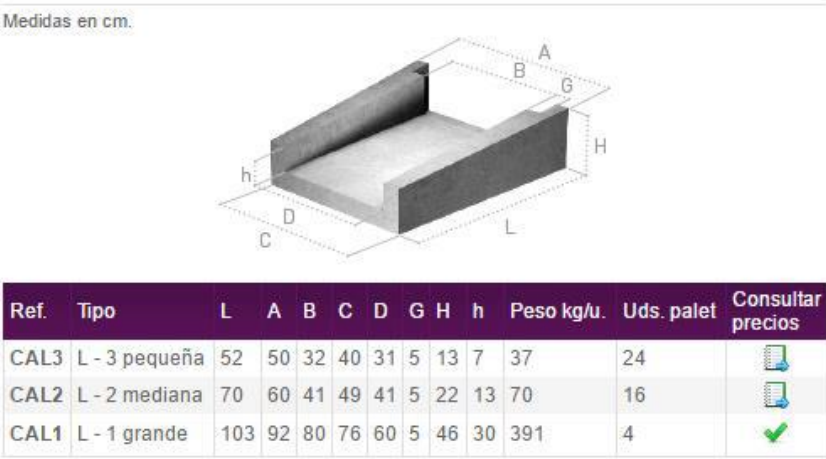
Geometría de bajantes prefabricadas de hormigón.
